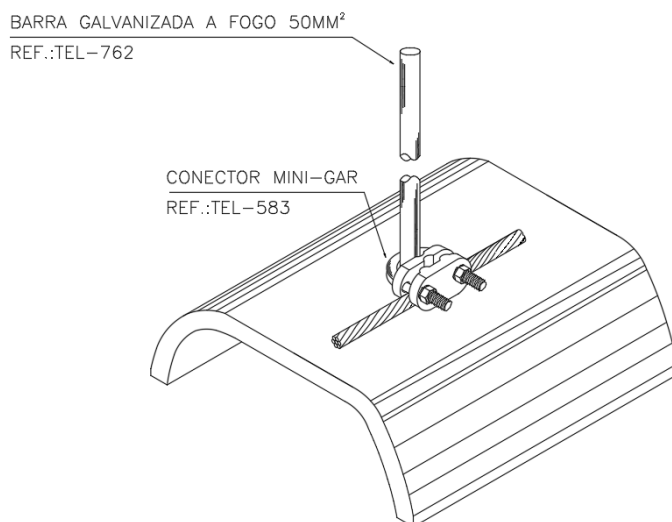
Interligação da captação com a RE BAR através de conector mini-gar
